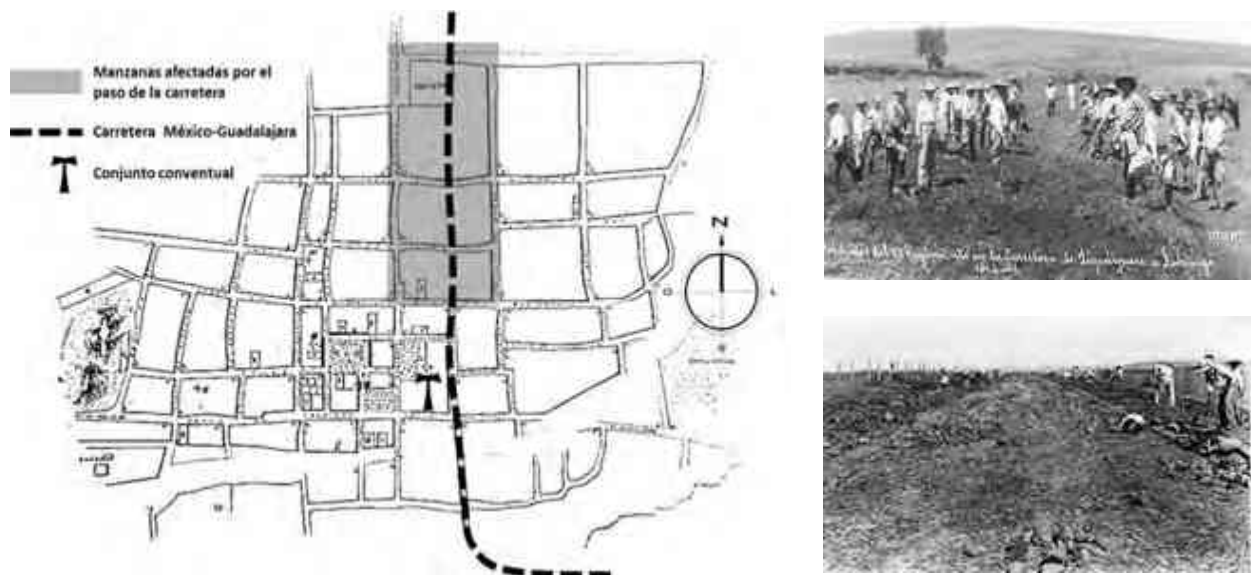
Plano de la ciudad de Jiquilpan, se ubica el trazo de la construcción de la carretera México-Guadalajara donde secciona manzanas que se localizan al norte del conjunto conventual de San Francisco y fotografías que ilustran el proceso de construcción con personas de la misma ciudad. Fuente: J. J. Segura Granados con datos del Acervo histórico cartográfico, Unidad Académica de Estudios Regionales, UNAM, Jiquilpan y Salvador Mesa Carrasco, Archivo personal.
